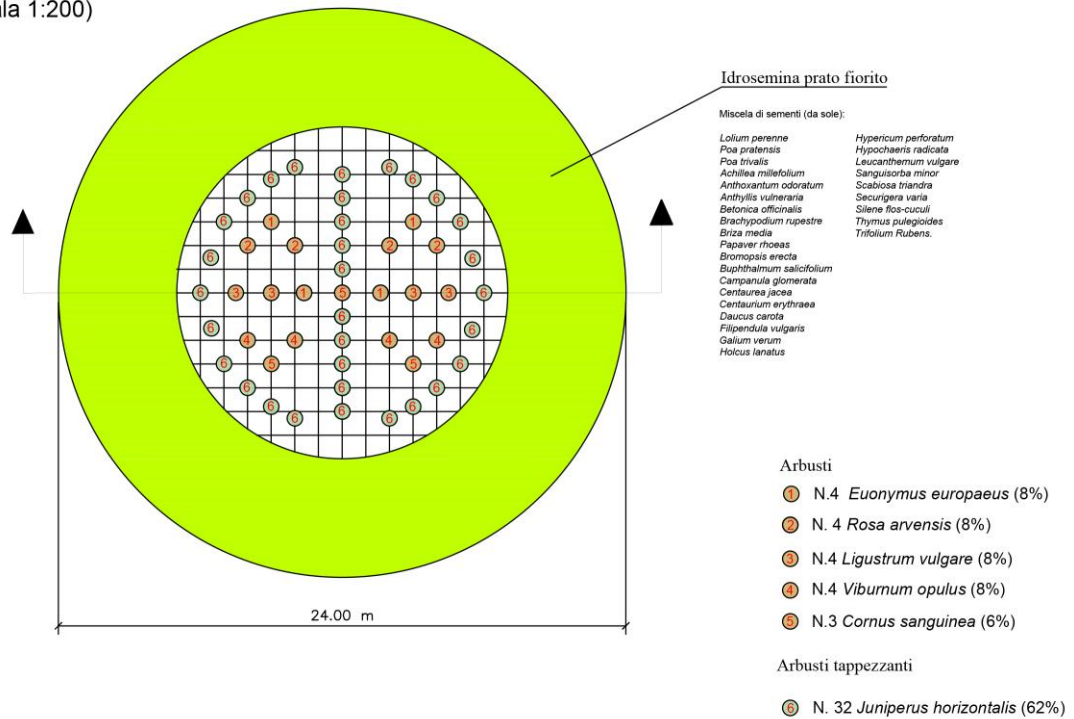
Pianta rotatoria modulo PI-RO 2
